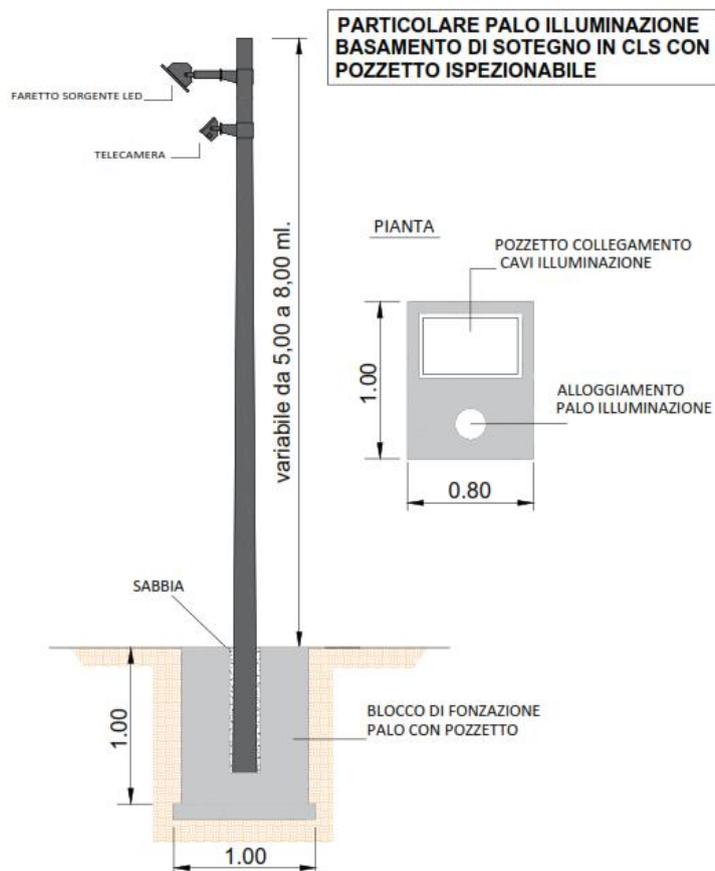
Particolare palo di illuminazione con pozzetto di fondazione e videocamera.
